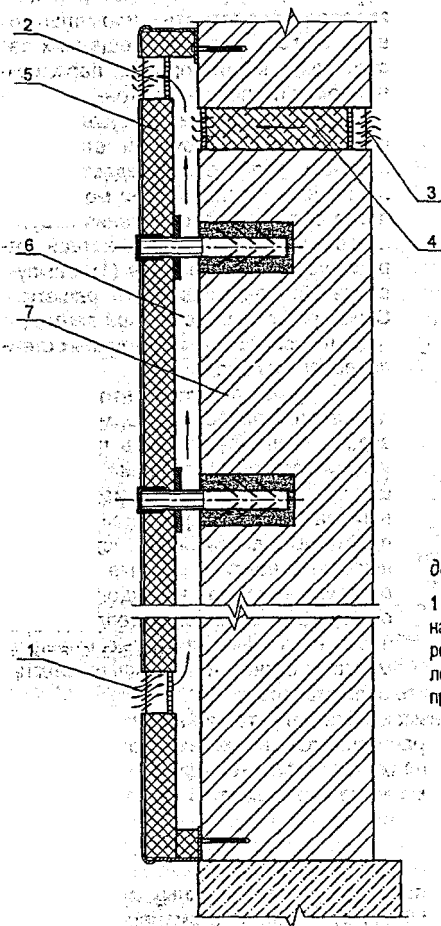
Схема работы естественной вентиляции наружных стен доутепленных способом "термический экран":
